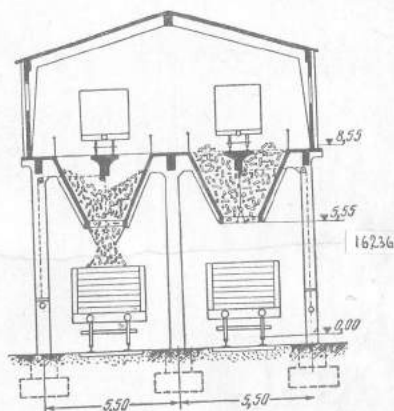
Поперечное сечение железобетонной эстакады.
